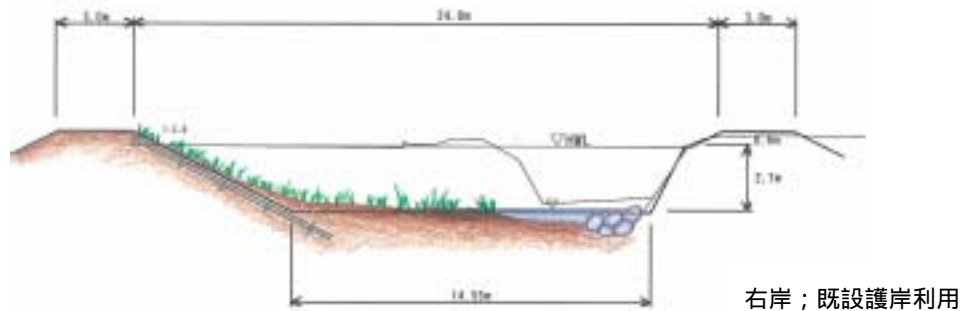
森川標準断面図（断面図はイメージを表す）
